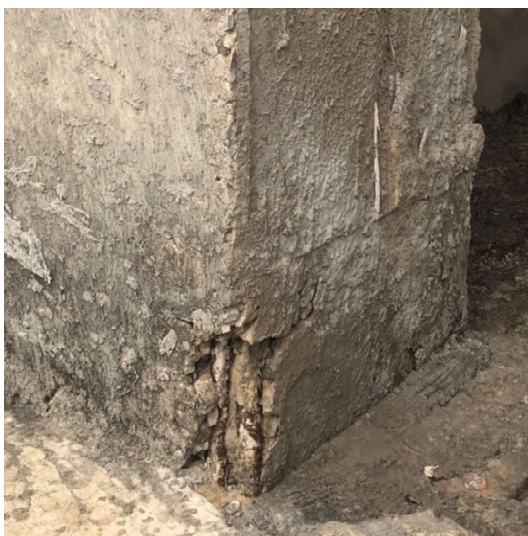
Armaduras expostas e corroídas. Arquivo pessoal (2020).
